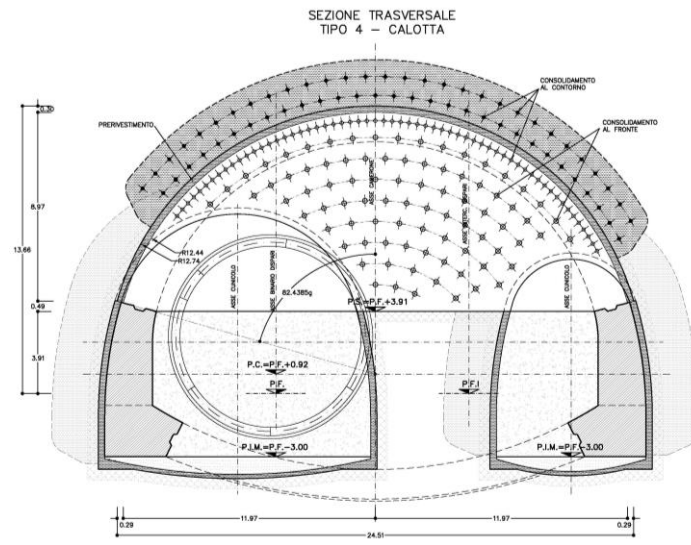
Consolidamenti in calotta sezione tipo 4
